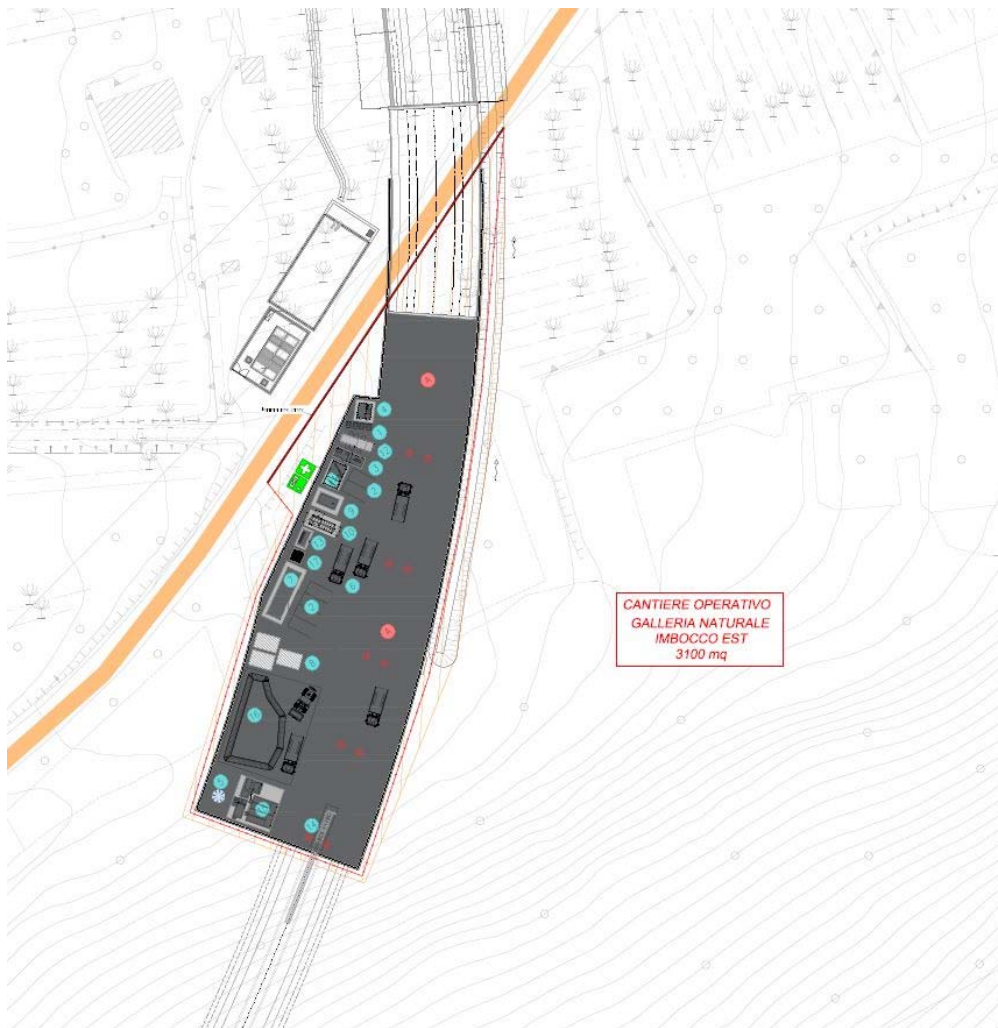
AREA CANTIERE IMBOCCO EST G.N.
